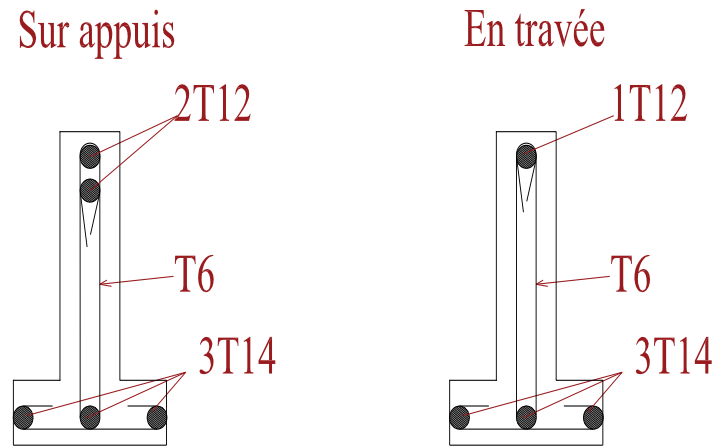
Schéma de ferrailage du poutrelle terrasse inaccessible
